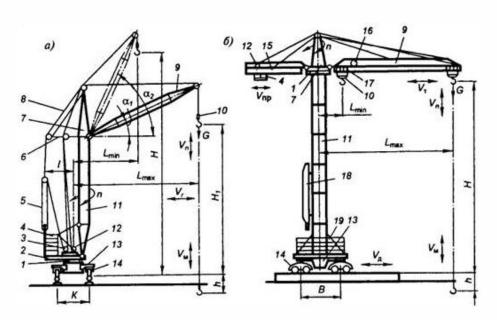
Типы и параметры башенных кранов: а – с поворотной башней; б – с неповоротной башней
